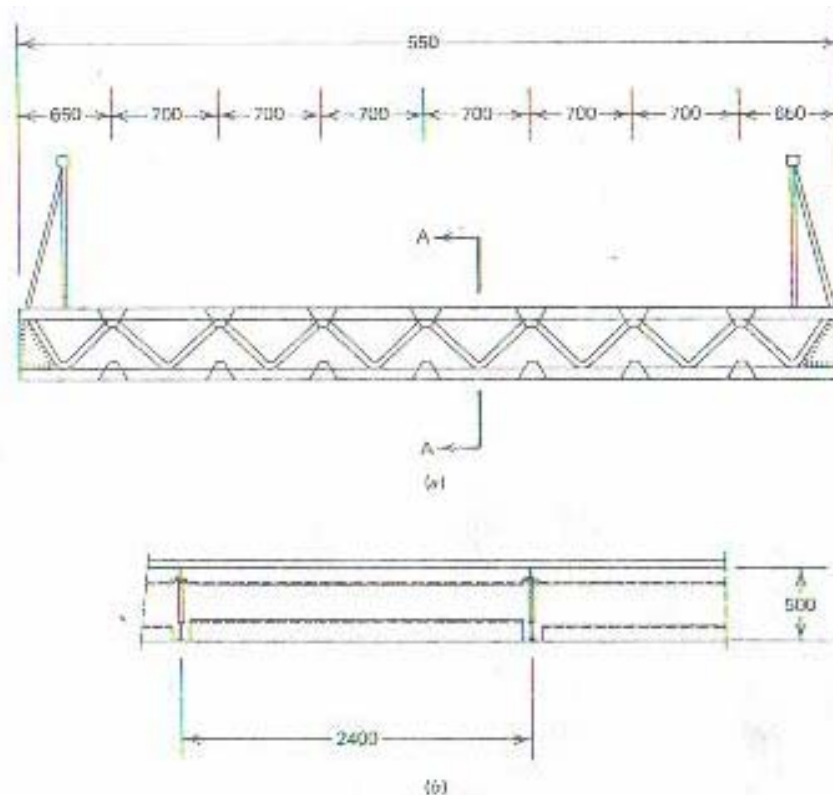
Puente peatonal Schillerstrasse: a) Sección de cruce en la losa; b) Sección A-A
